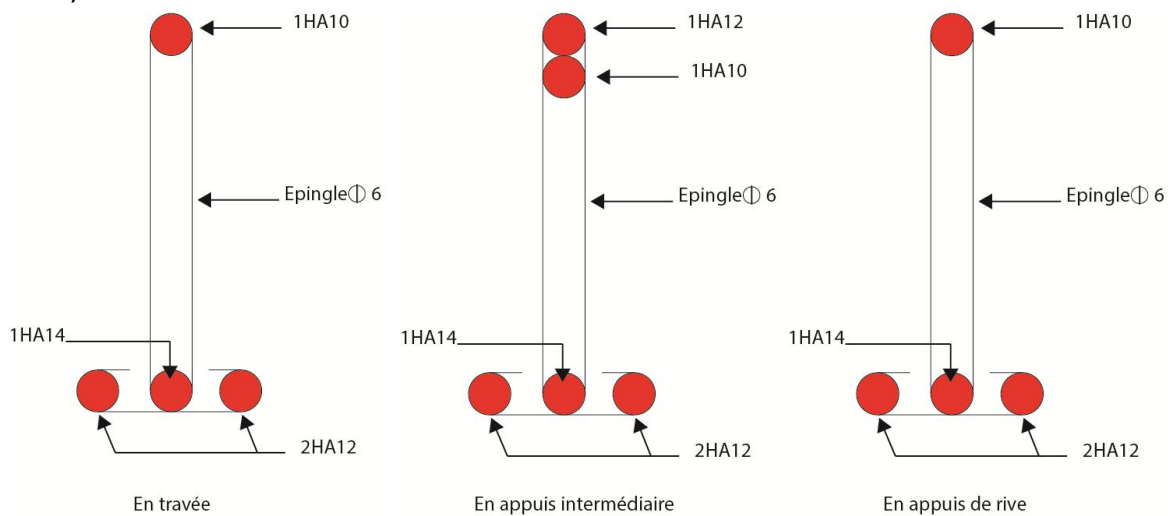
Schéma de ferrailage des poutrelles de la terrasse inaccessible.
